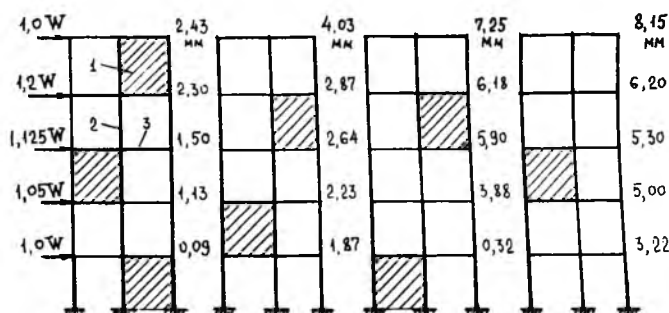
Схемы испытаний (а-г) каркасных поперечников в КиевЗНИИЭП (в уровне перекрытий указаны горизонтальные прогибы в мм)
